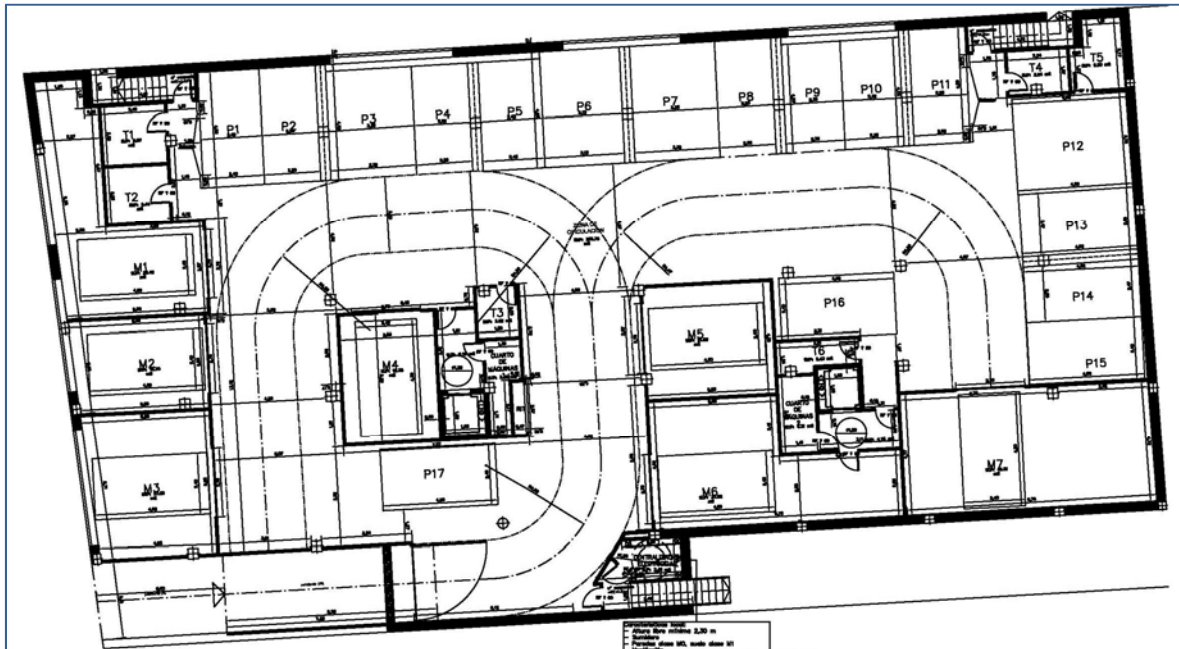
Plano de planta sótano. Procede del Proyecto de Ejecución.
